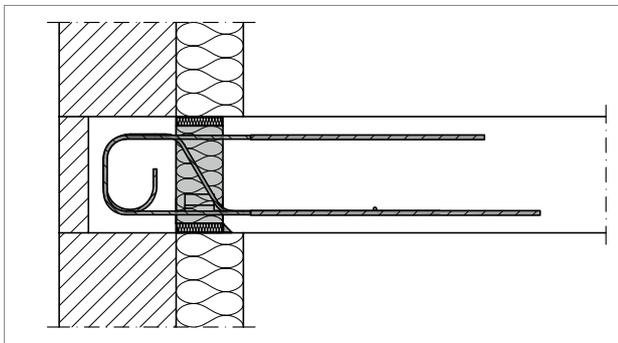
Schöck Rutherma® T type DFi : liaison pour façade en maçonnerie et dalle en béton coulé sur place
